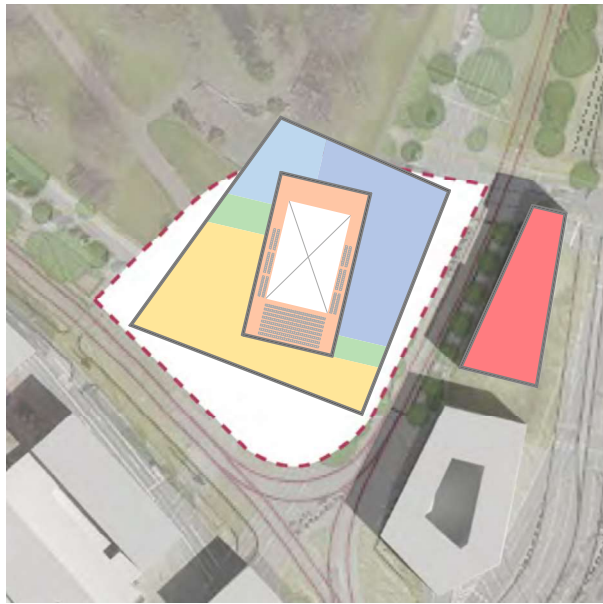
Grundriss OG1 Bahnhofsquartier V2
